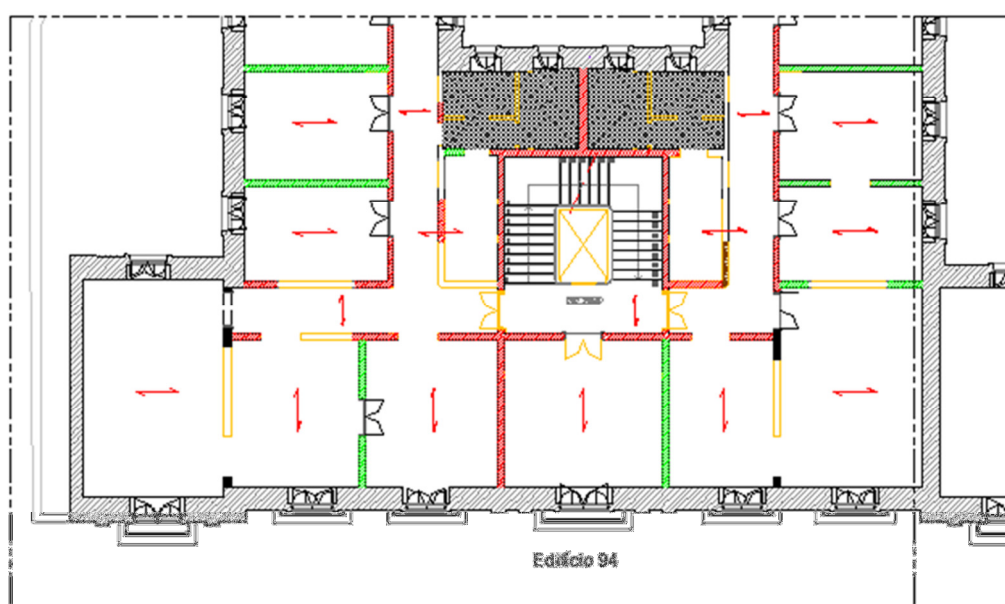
Orientação dos vigamentos de madeira [37].
